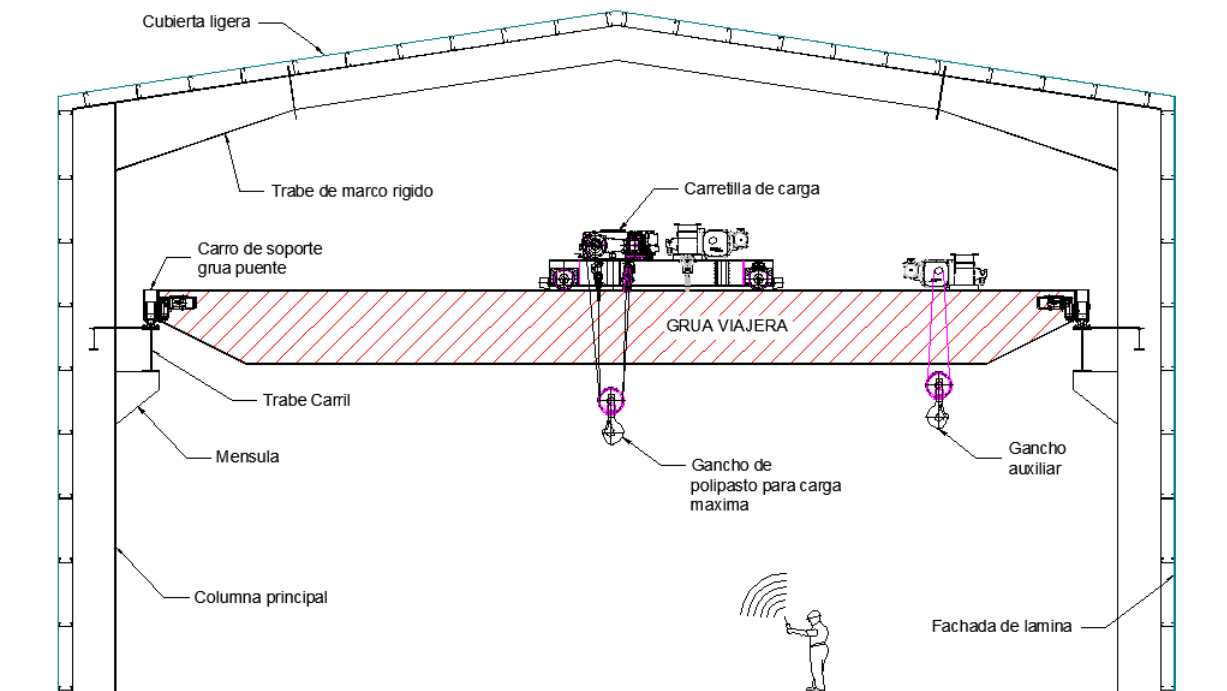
Estructura principal a base de columnas en de concreto o acero con apoyo de ménsula para trabe carril y trabe de acero de sección variable a dos aguas para la cubierta
